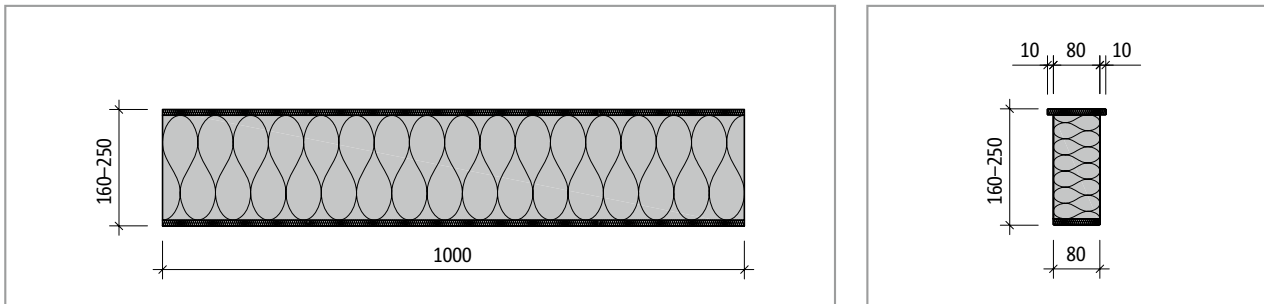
Schöck Isokorb® T tipo Z-EI120-T-L1000: Vista y sección del producto
